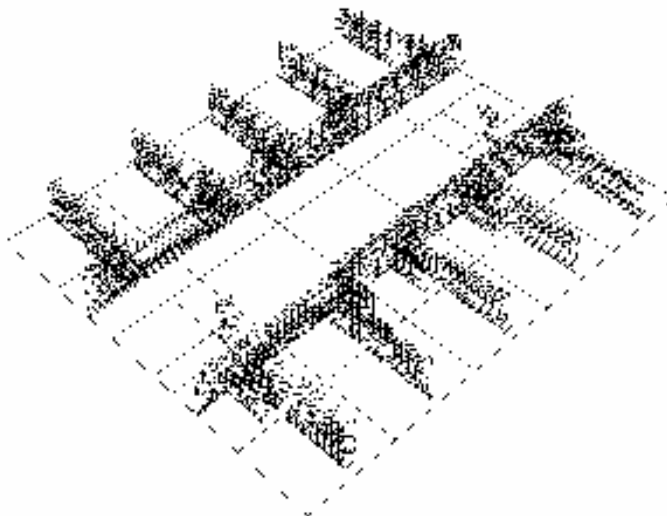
Carregamento de peso próprio das paredes sobre as lajes.
